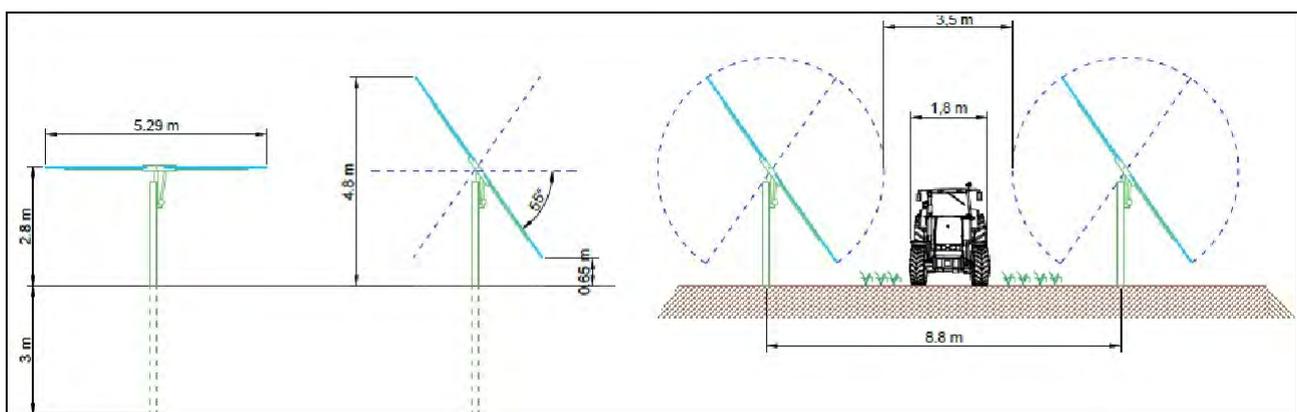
Progetto strutture – Allegato C_049_DEF_T_24
